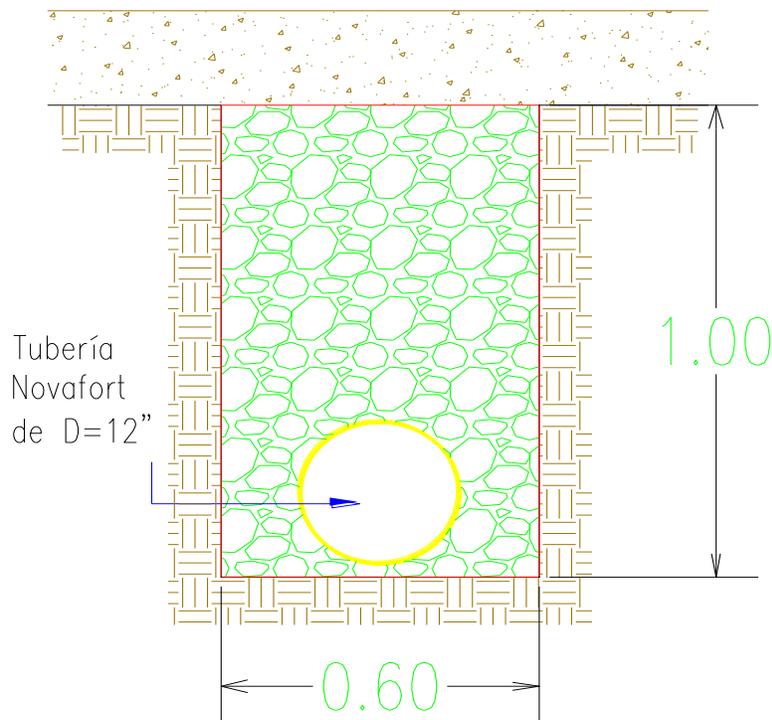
Sección transversal de filtro francés. (Fuente: Pasante).
